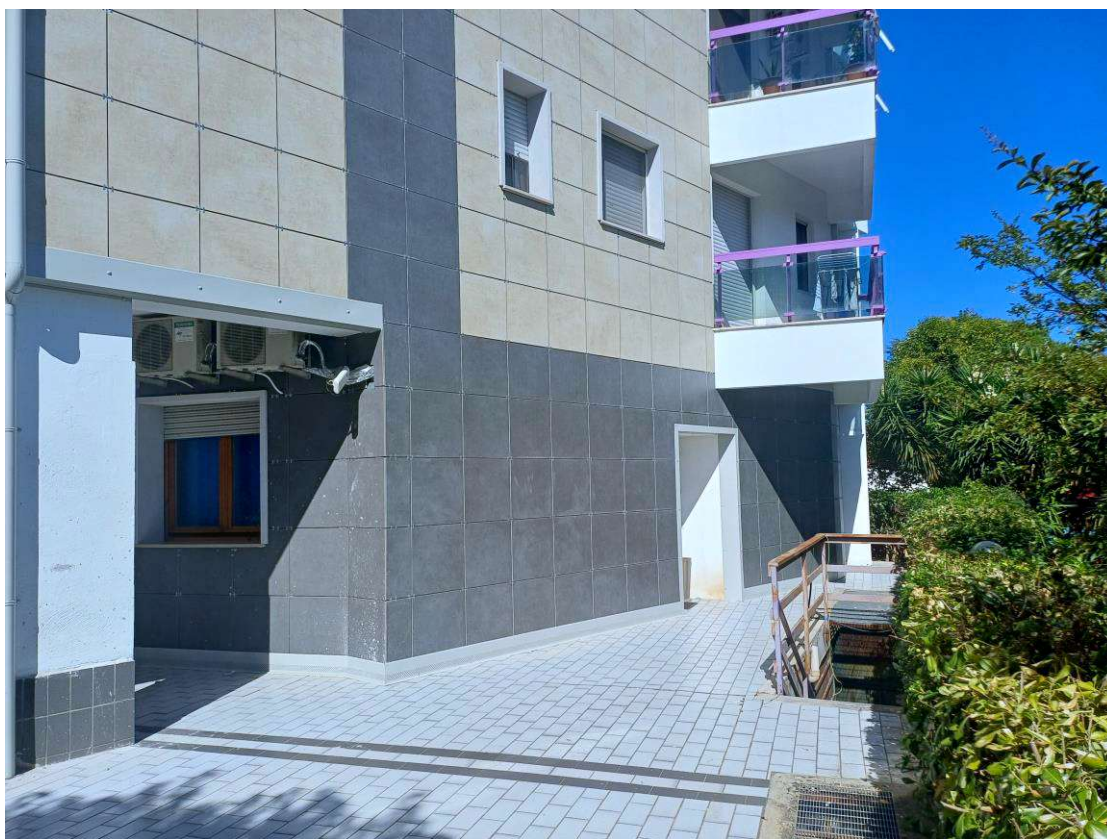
Prospetto fabbricato Est con ingresso immobile oggetto di stima
